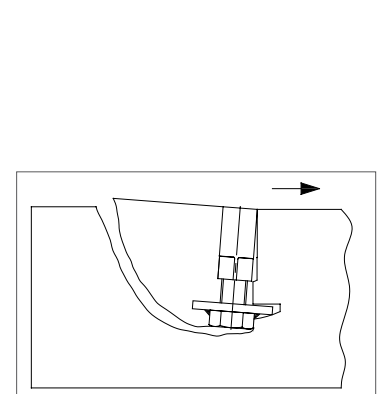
Lokaler Betonausbruch (Blow-Out)
